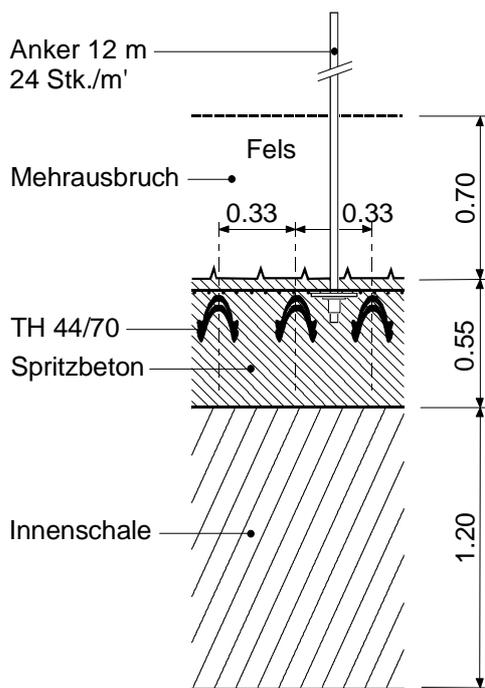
Schnitt durch den zeitweiligen und endgültigen Ausbau senkrecht zur Tunnelachse (ungünstigster Gebirgsbereich) nach gänzlichem Ausschöpfen der eingeplanten Konvergenz
